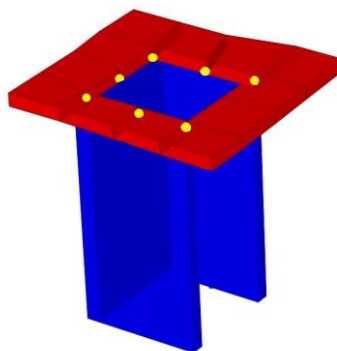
Núcleo de elevador(azul) com elementos shell(vermelho) e respectivo constraint(amarelo).
